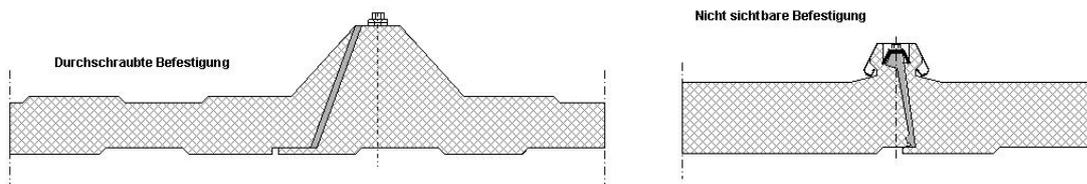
Befestigungsvarianten von Sandwichdachsystemen
